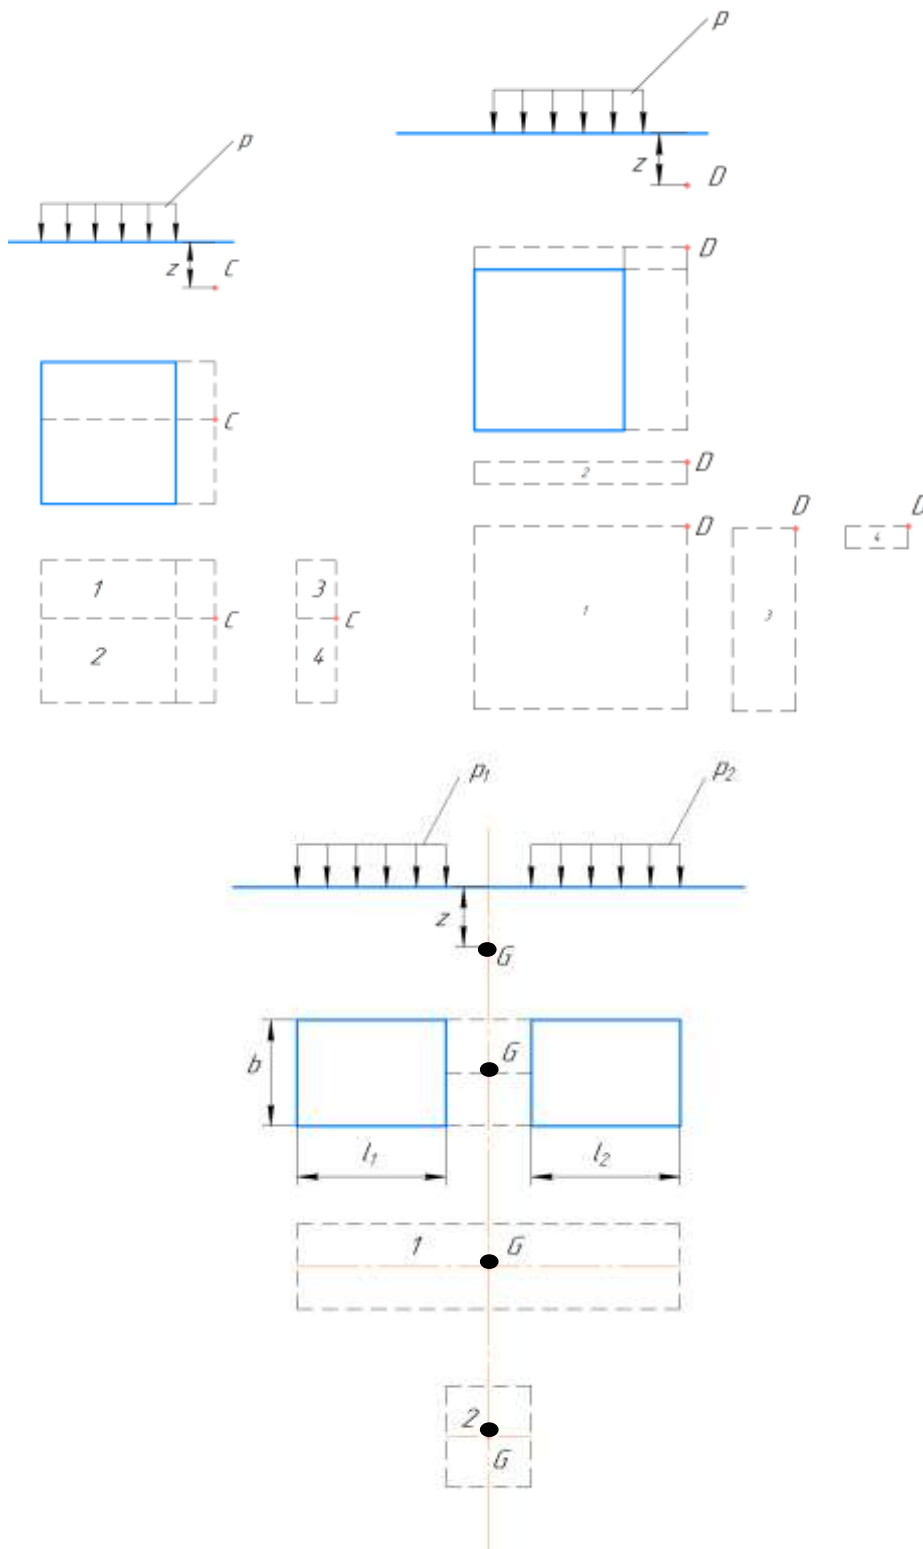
Схемы разбивки прямоугольных нагруженных площадок [1]
